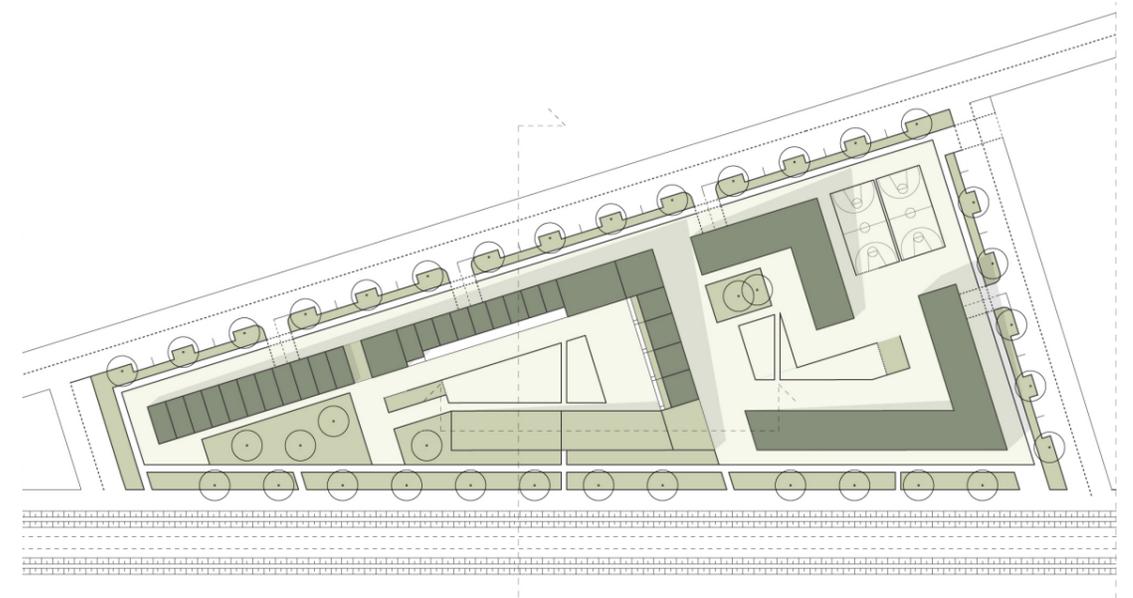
Lageplan: neues Quartier mit Wohnungen und Gewerberäumen
